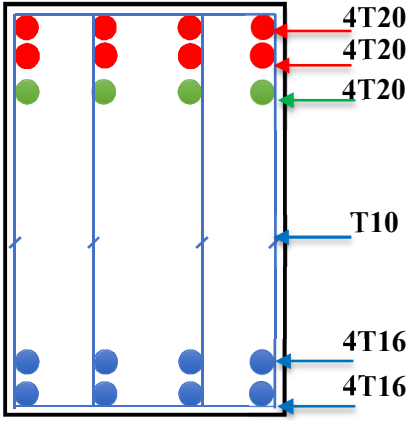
Ferrailage de la poutre de libage (sens longitudinal)
